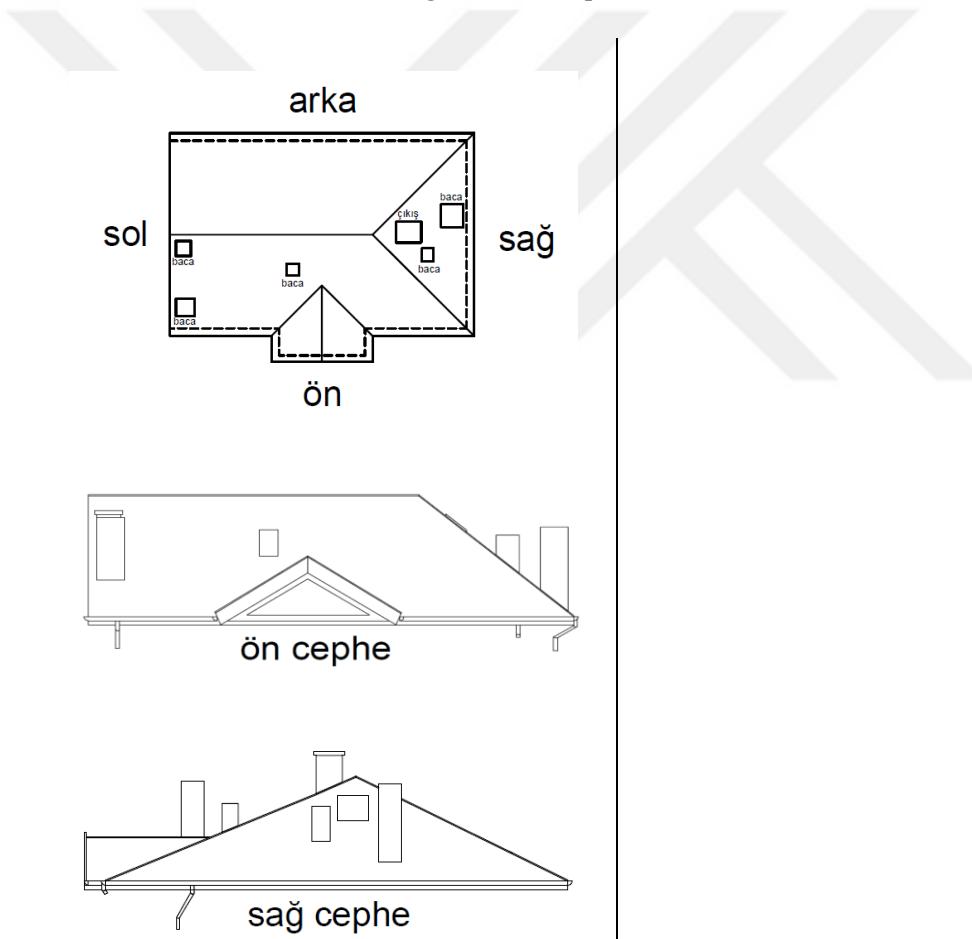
Konak ön ve sağ yan cephe görünümü
